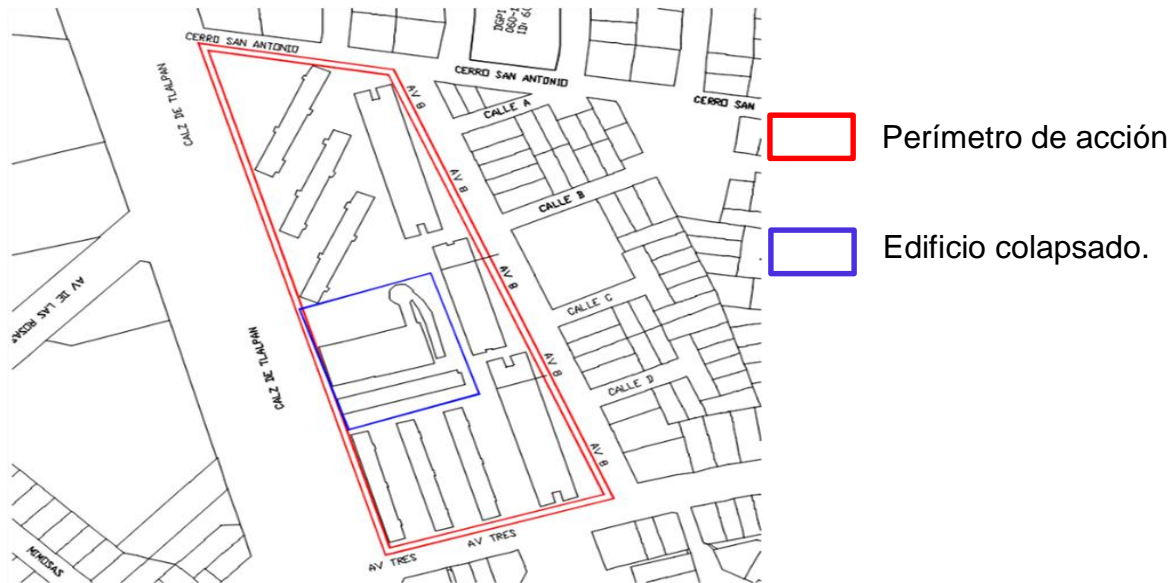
Plano catastral con zonas a intervenir. Fuente: Elaboración propia.
